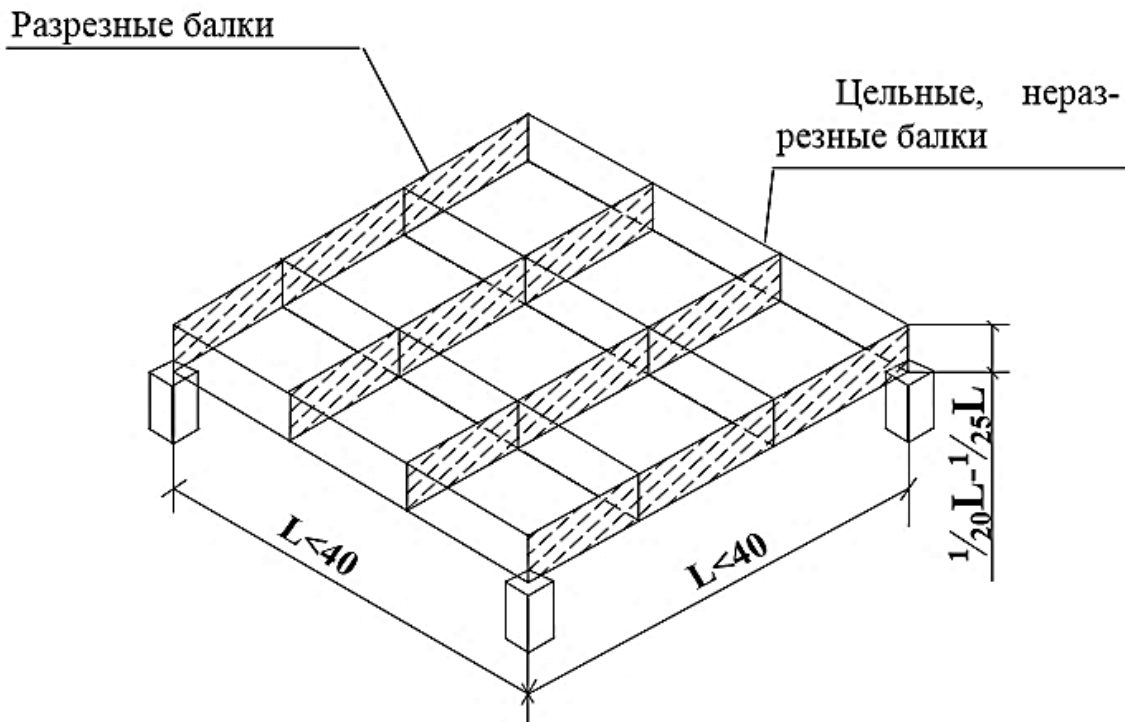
Общая схема перекрестных конструкций покрытия
